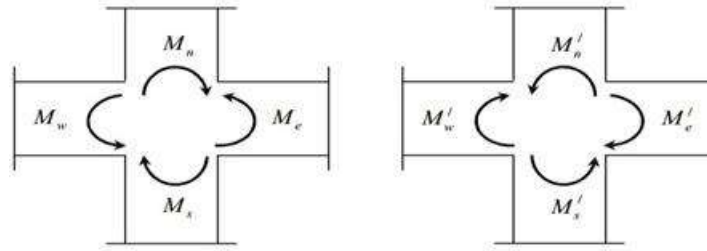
Dimensionnement d'un nœud poteau-poutre.
